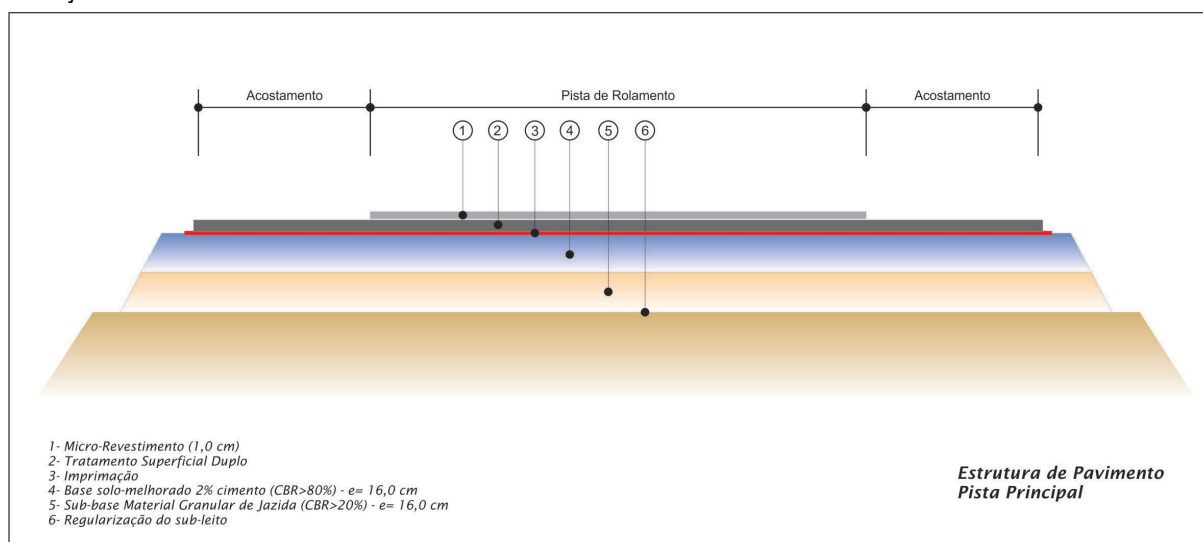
Estrutura de pavimento projetada para o Arco Viário e Interseção 01
